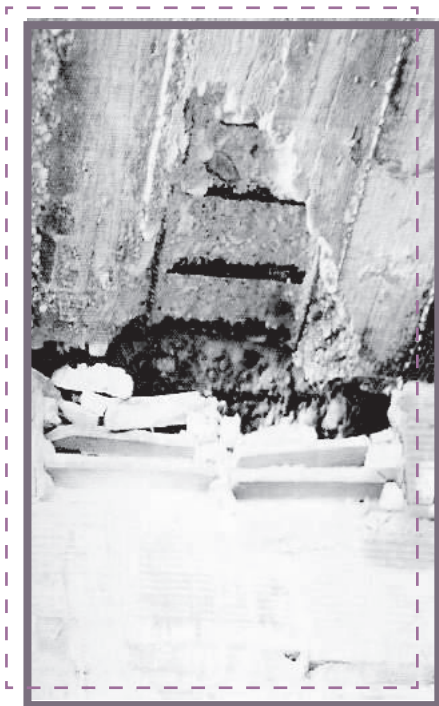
Imagen de las fisuras en viga de hormigón armado por excesiva flecha.
